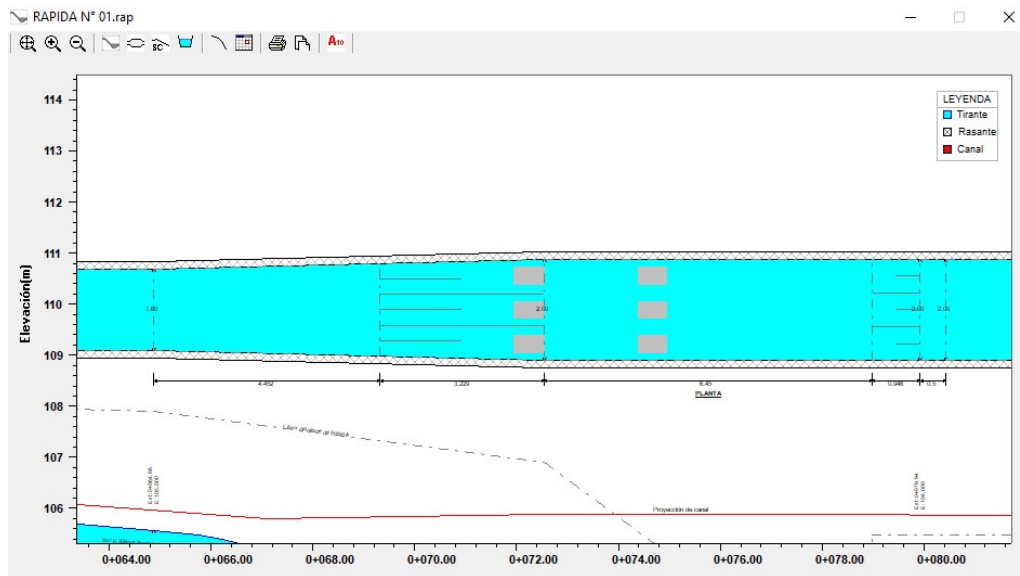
Vista de planta de Rápida N° 01 - “Software Rápida V.01”
